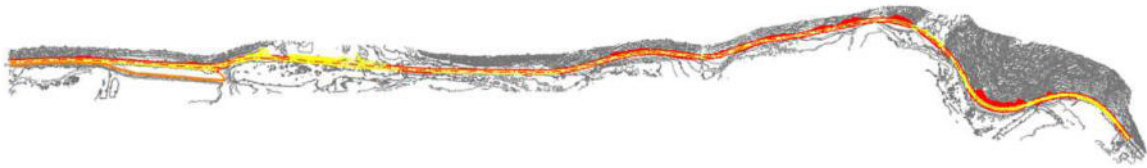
Planimetria di progetto per l'alternativa prescelta
